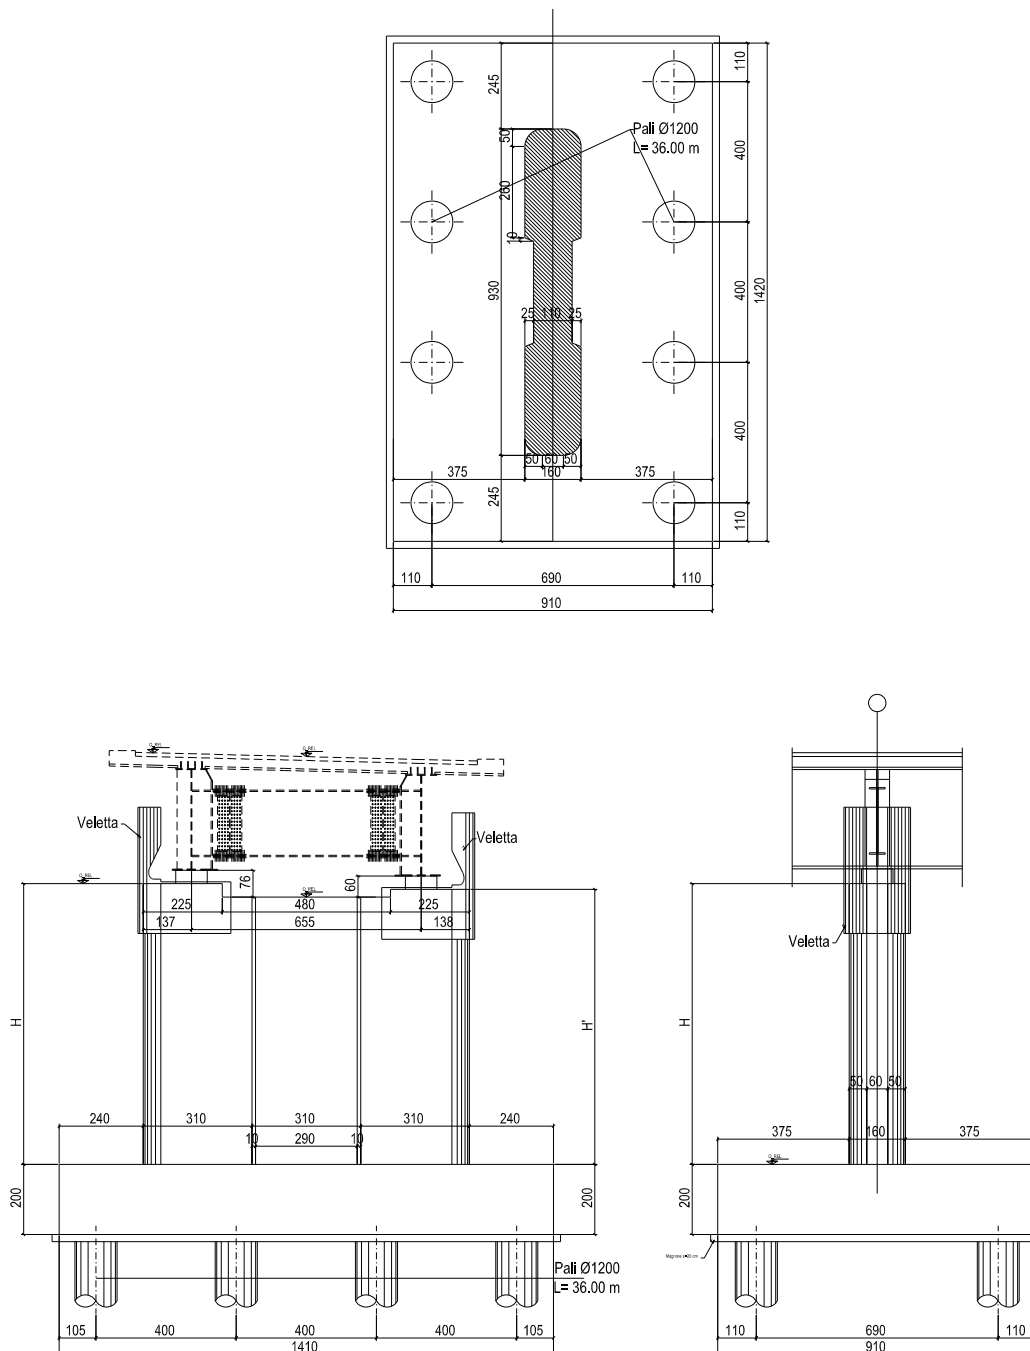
Sezione trasversale, vista trasversale e longitudinale delle pile 1 e 2
